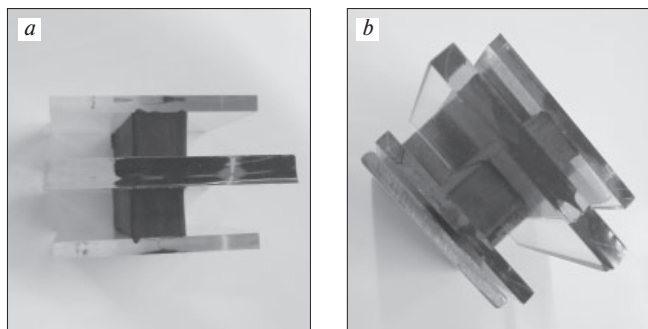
Образец-шов стекло–стекло–стекло для проведения испытаний на сдвиг: a – образец-шов; b – образец-шов установлен в приспособление для испытаний на сдвиг
